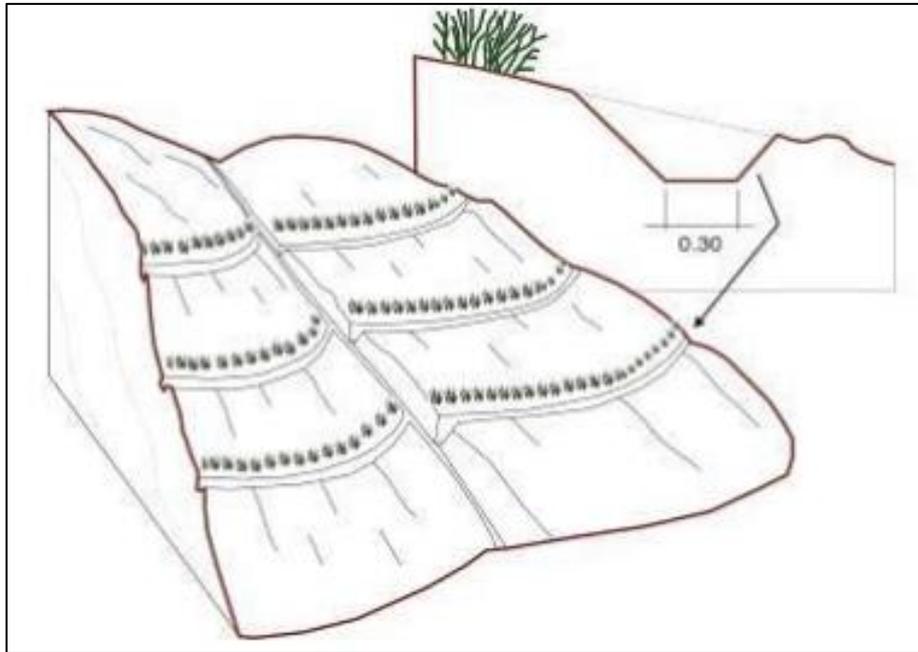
Sistema de drenaje en laderas ocupadas por cultivos.
